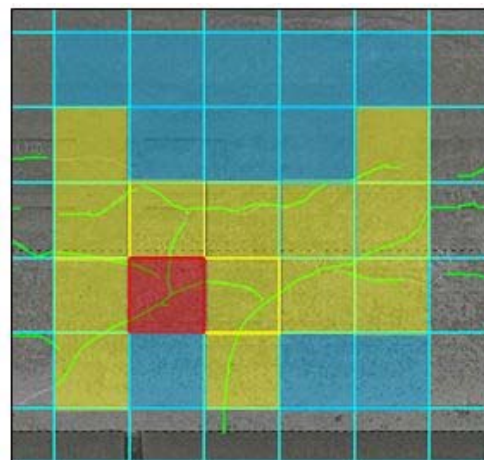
ひび割れ密集箇所の抽出イメージ
